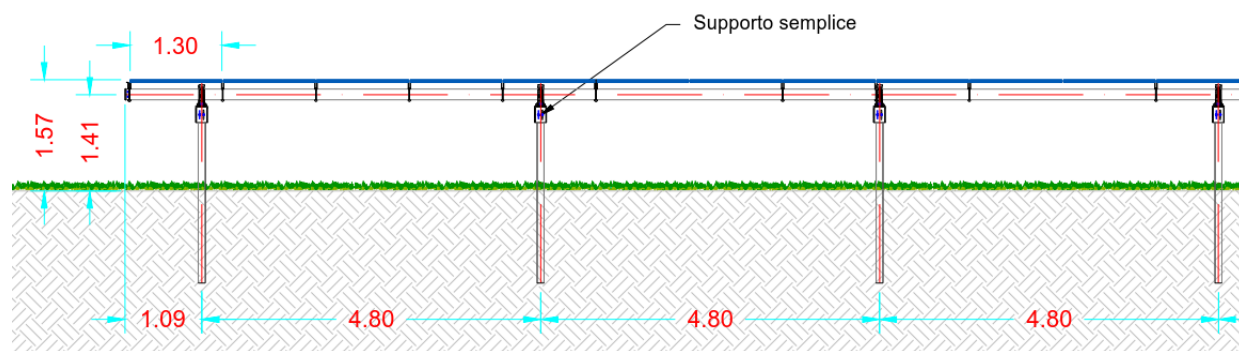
Sezione longitudinale tipologica struttura Tracker – Aree 01, 02, 03, 04
